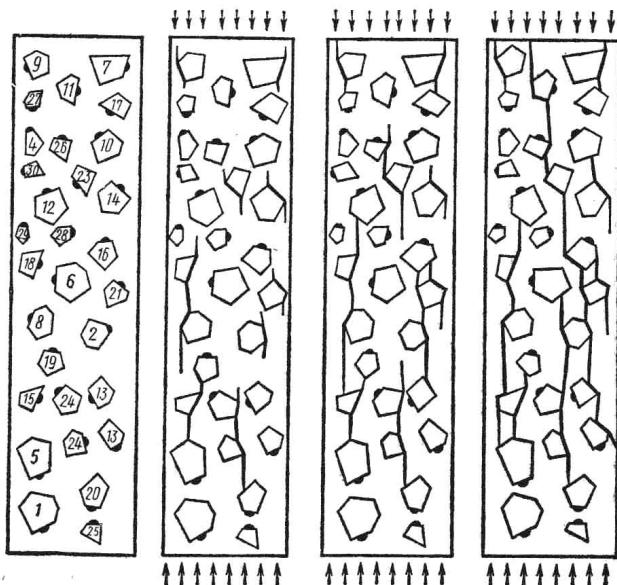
Последовательные этапы развития трещин в бетонной призме при сжатии
